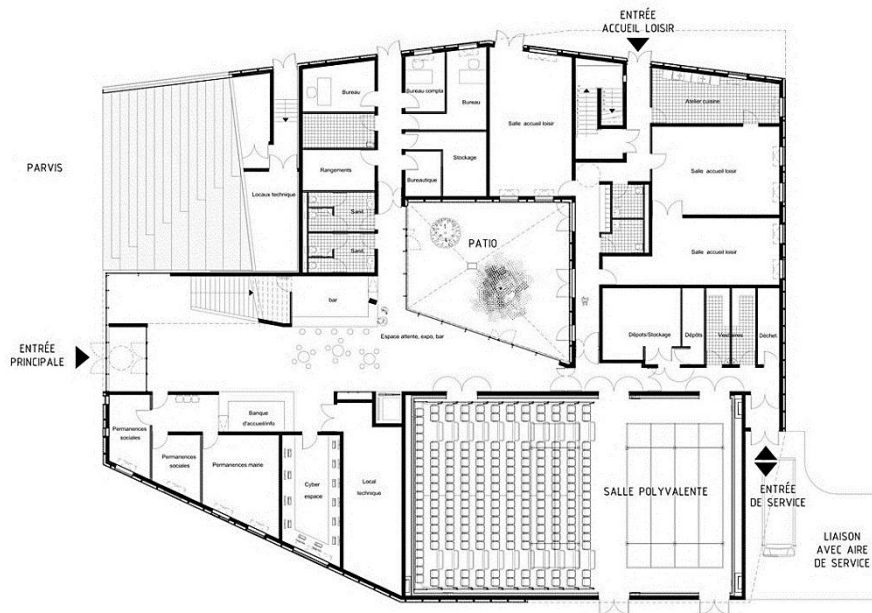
Planta Arquitectónica, Centro Cultural en Nevers
